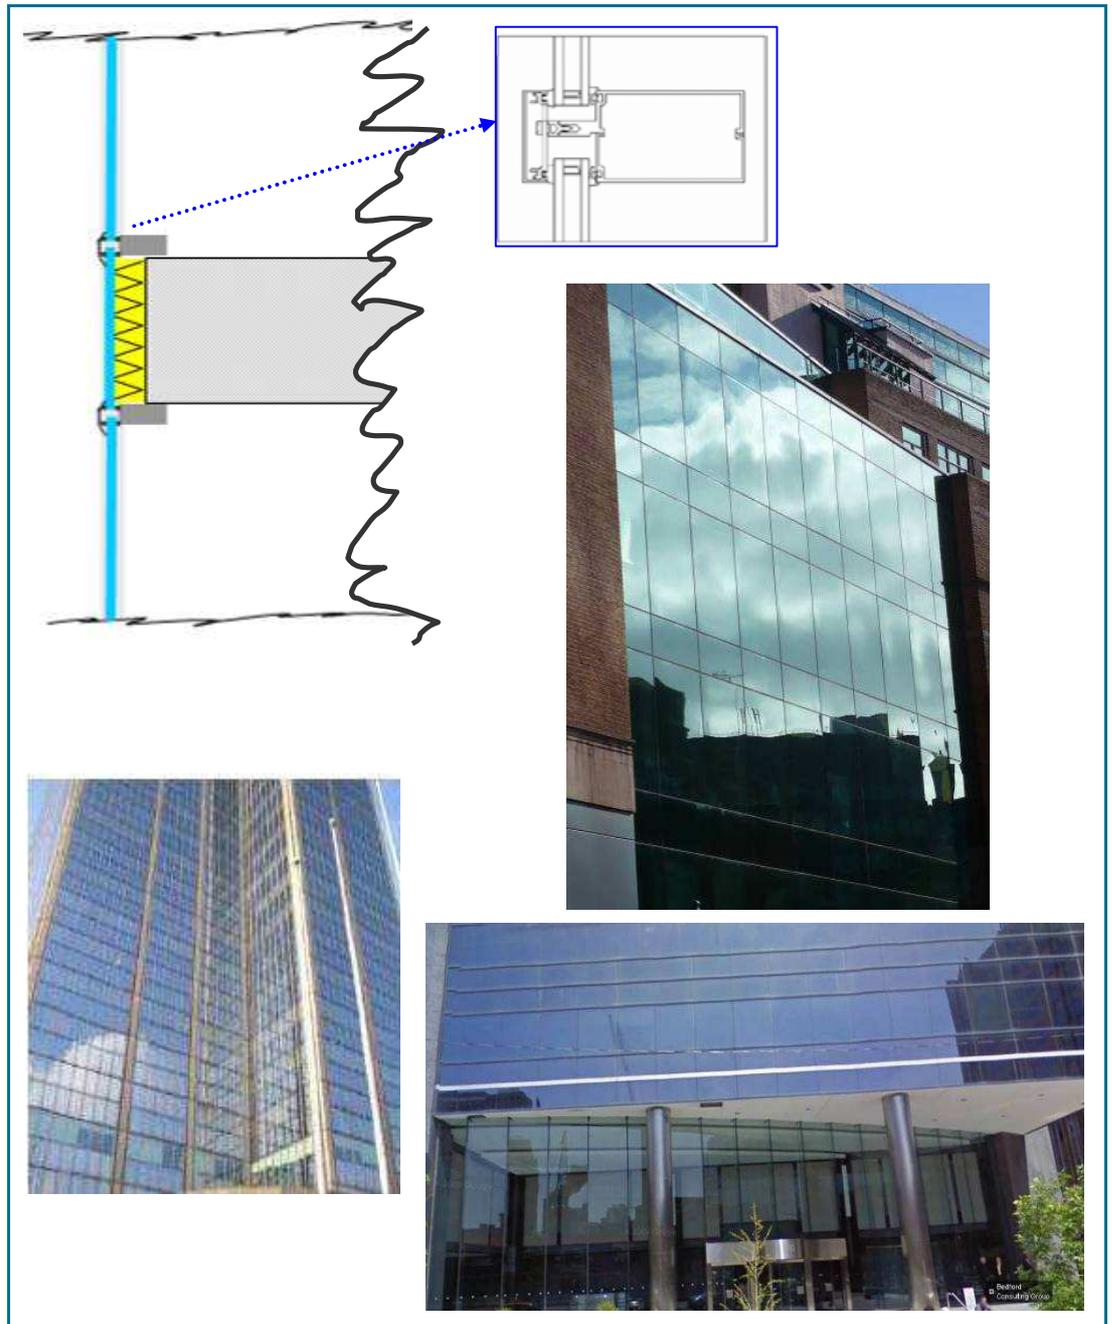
Façades rideaux entièrement vitrée (En haut à gauche : coupe verticale à hauteur du plancher, ailleurs : photos de l'extérieur en élévation)
